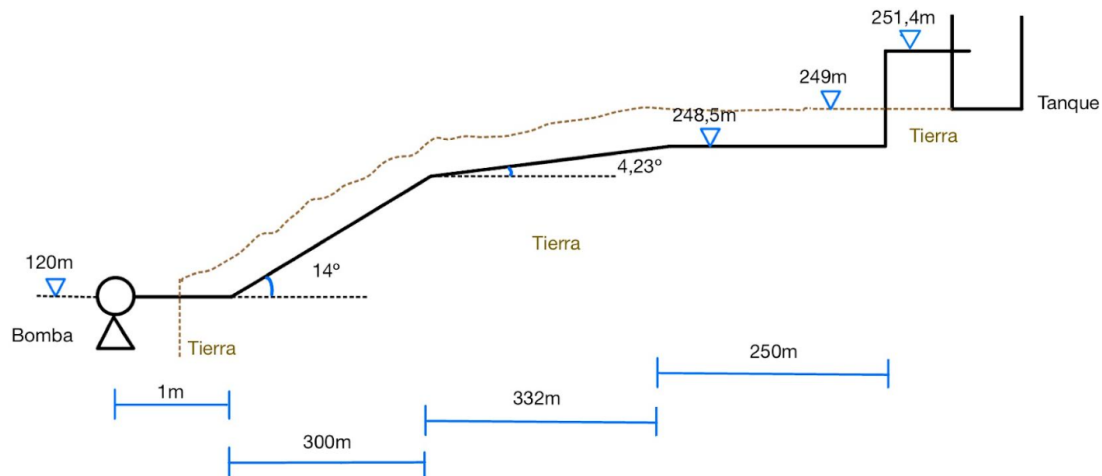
Esquema no a escala de cotas y medidas del recorrido de la tubería de conducción. Fuente: Elaboración propia
